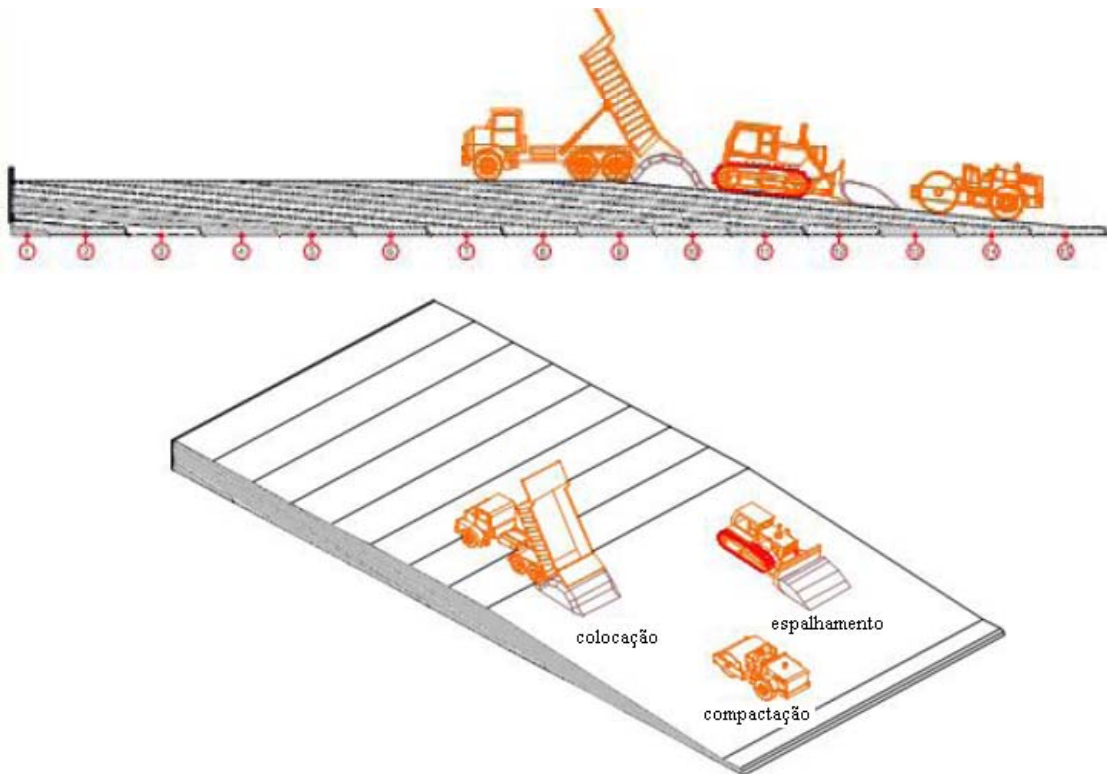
Etapas da colocação do BCC em obra pelo método rampado (Andriolo, 2008).
